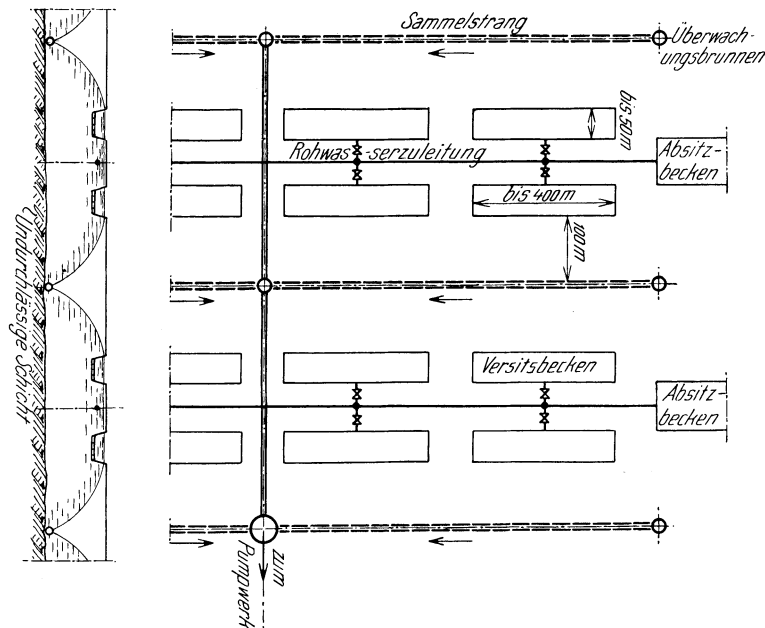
Schema einer Anlage zur Erzeugung künstlichen Grundwassers
